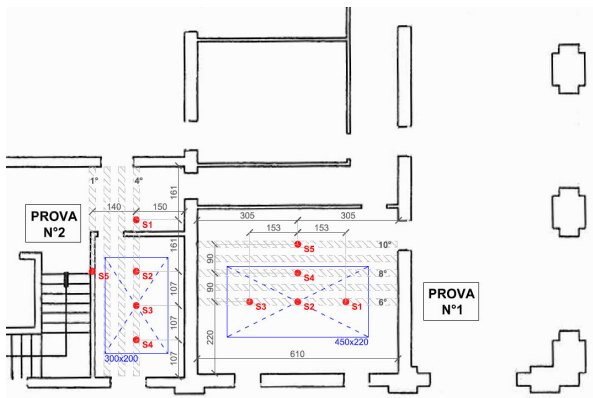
prova n°1-2 (Barchessa di ponente, solai o 1° piano)
